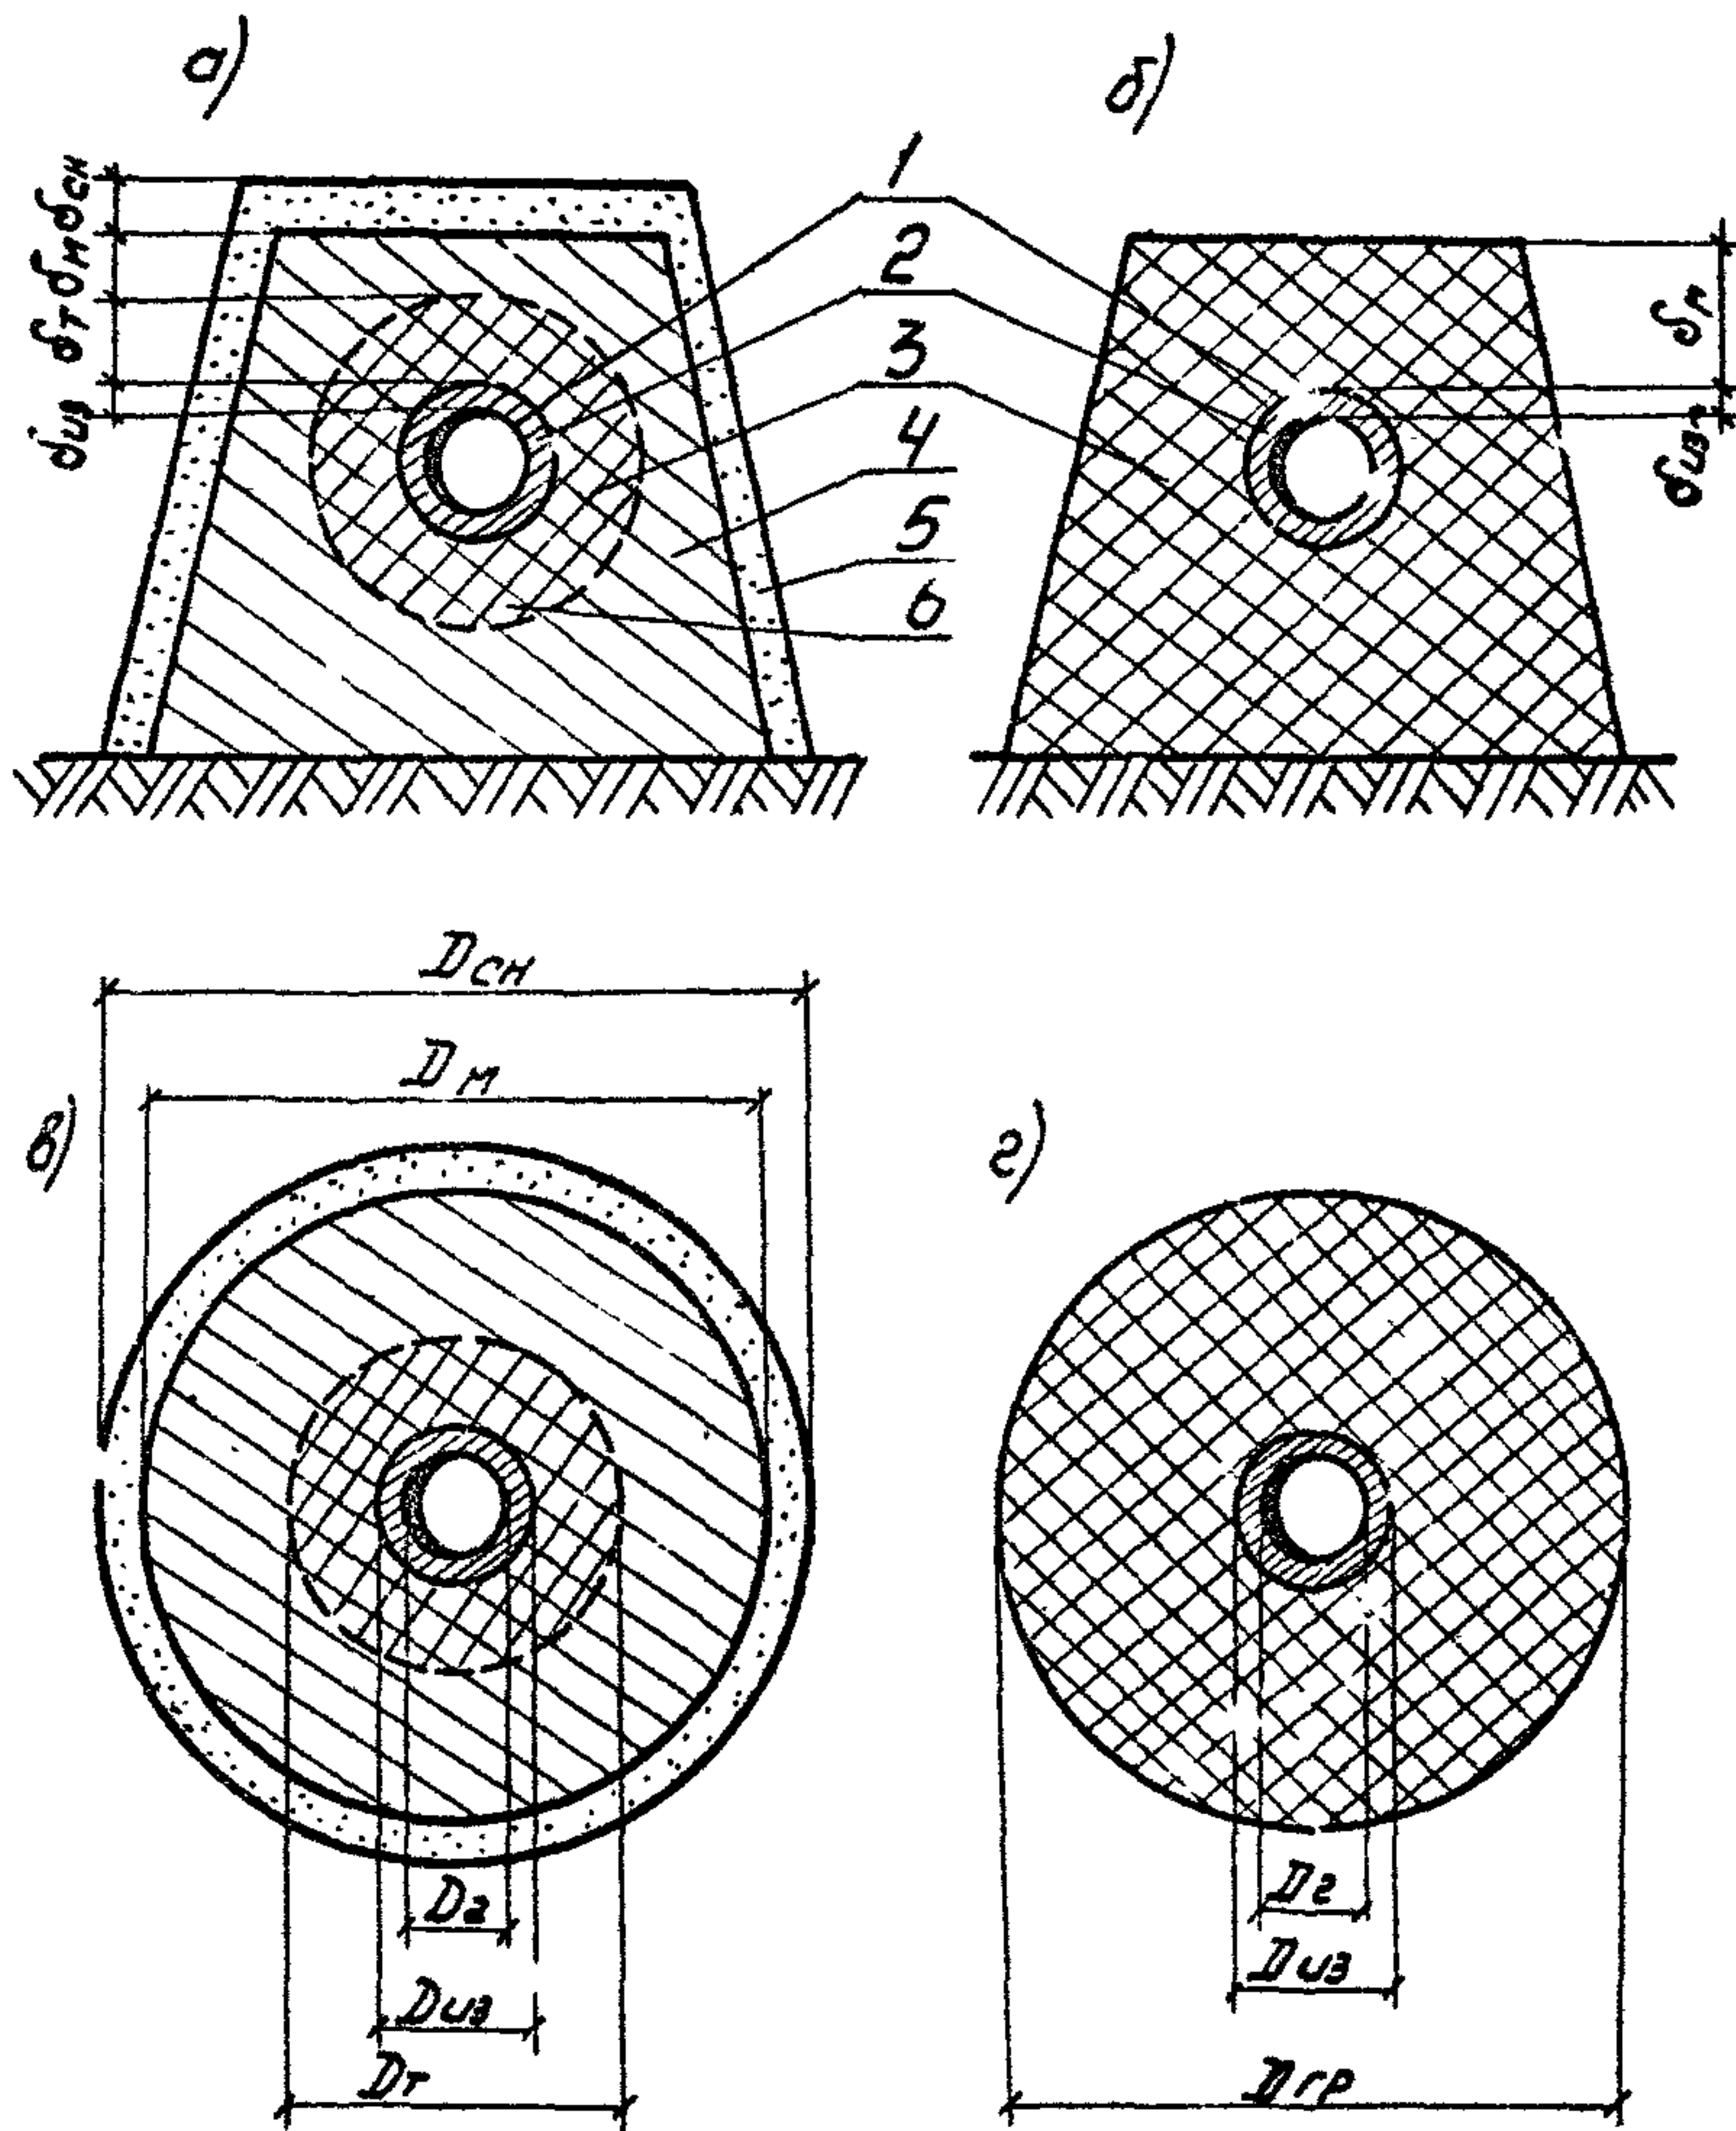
Расчетные схемы для трубопроводов, уложенных в насыпи
